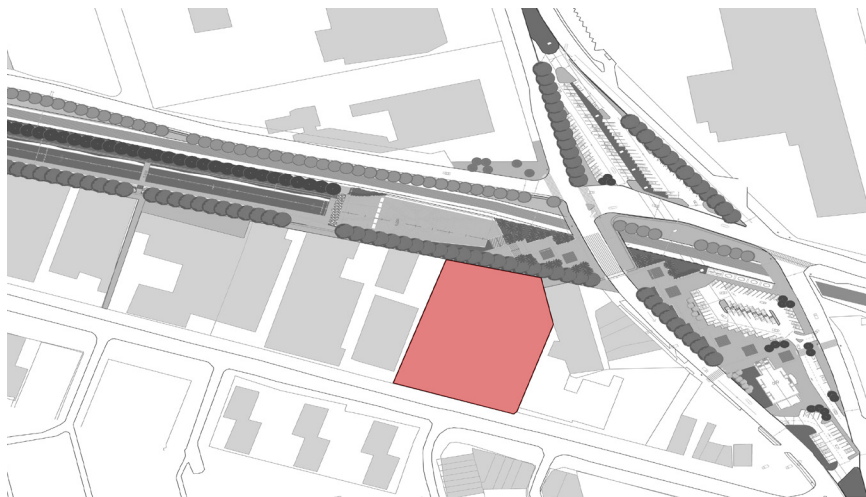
Planta de terreno con tramo de parque incluido.
